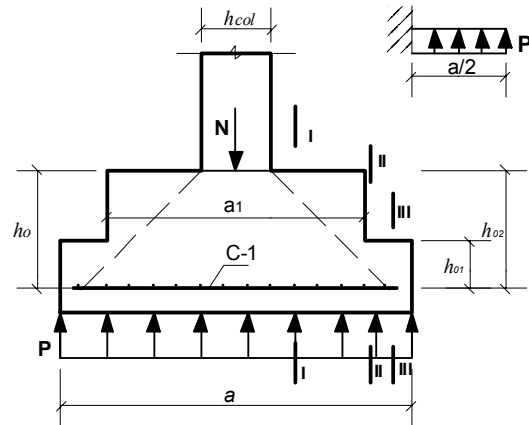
Розрахункова схема центрально стиснутого фундаменту
